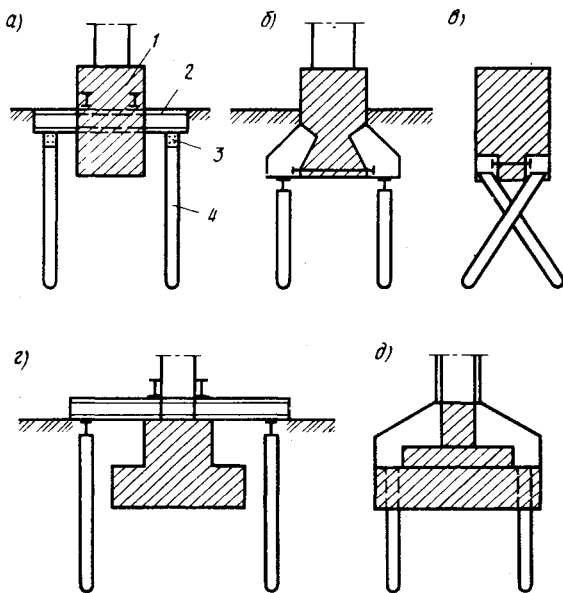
Усиление ленточных и одиночных фундаментов набивными сваями:
